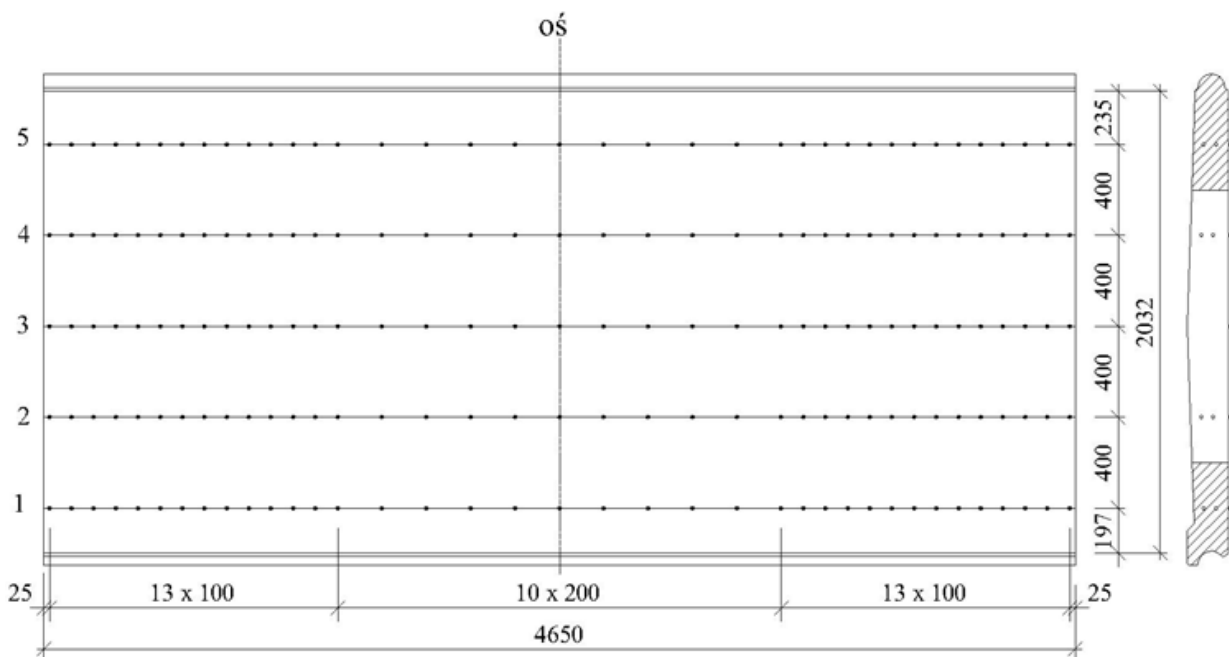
Przekrój poprzeczny prefabrykowanego elementu
